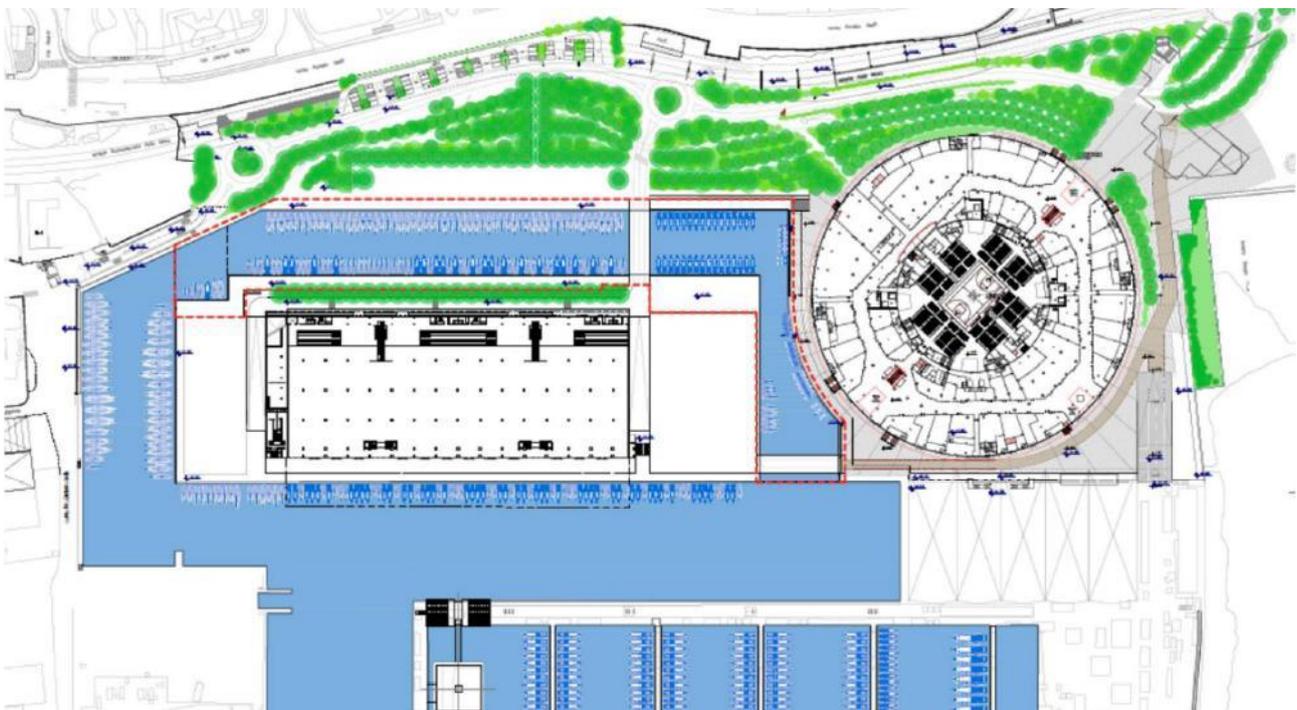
Planimetria generale di progetto a quota +5,50 – Stralcio elaborato SIA.T02.
